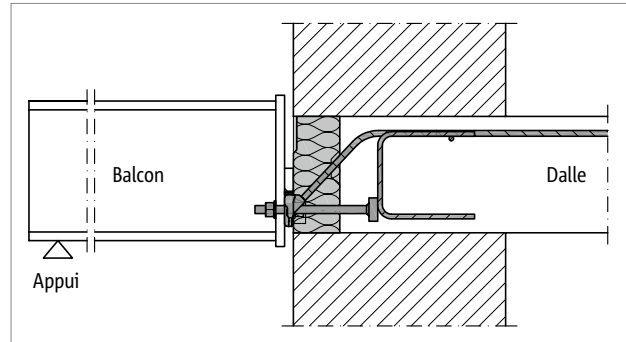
Schöck Isokorb® T type SQ : raccordement à la dalle en béton armé ; mur avec isolation répartie
